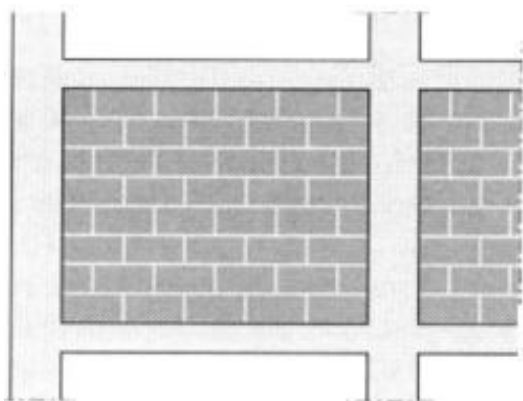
Structure en portique (poteaux – poutres), 80 % à 90 % de la construction dans la zone sinistrée
